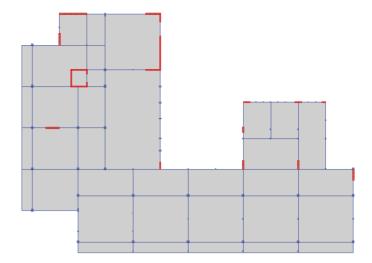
Planta tercer piso, Liceo Politécnico Pitrufquén.
